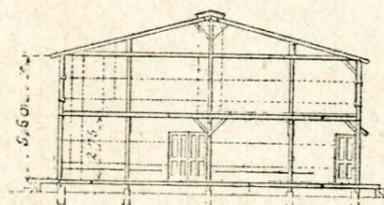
Sezione di un baraccamento attraverso ai dormitori.
